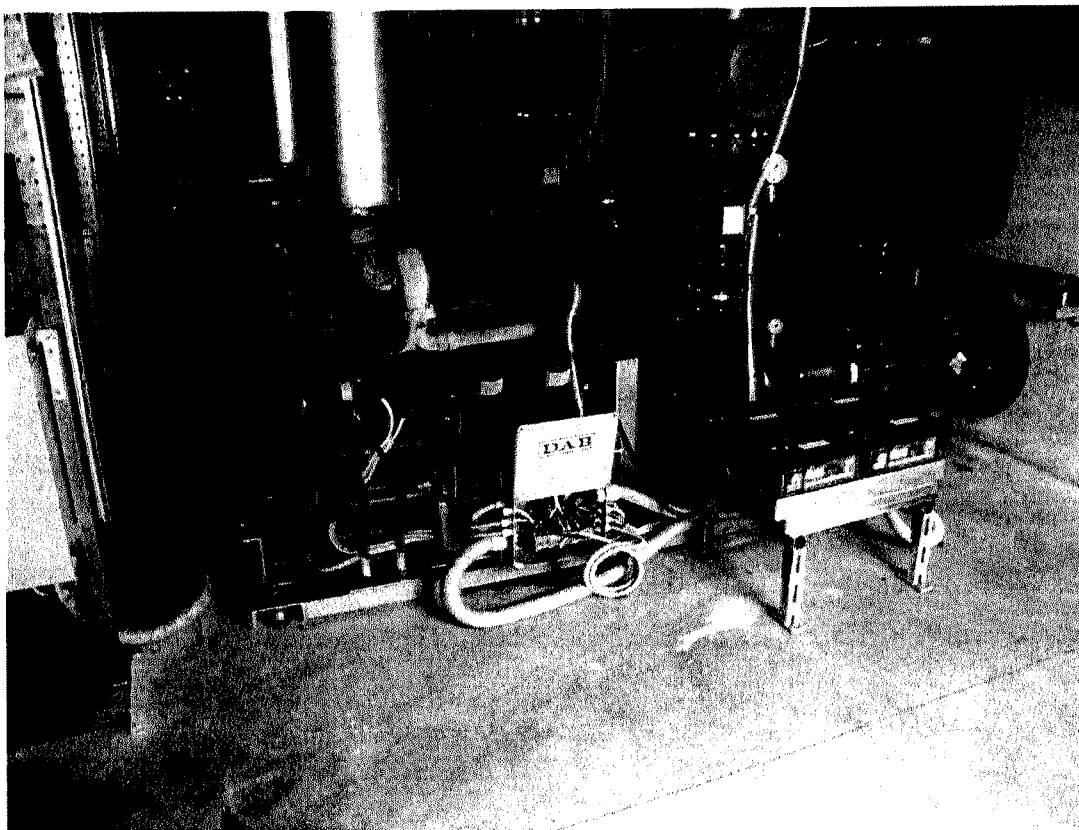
particolare impianto antincendio vano pompe piano interrato
